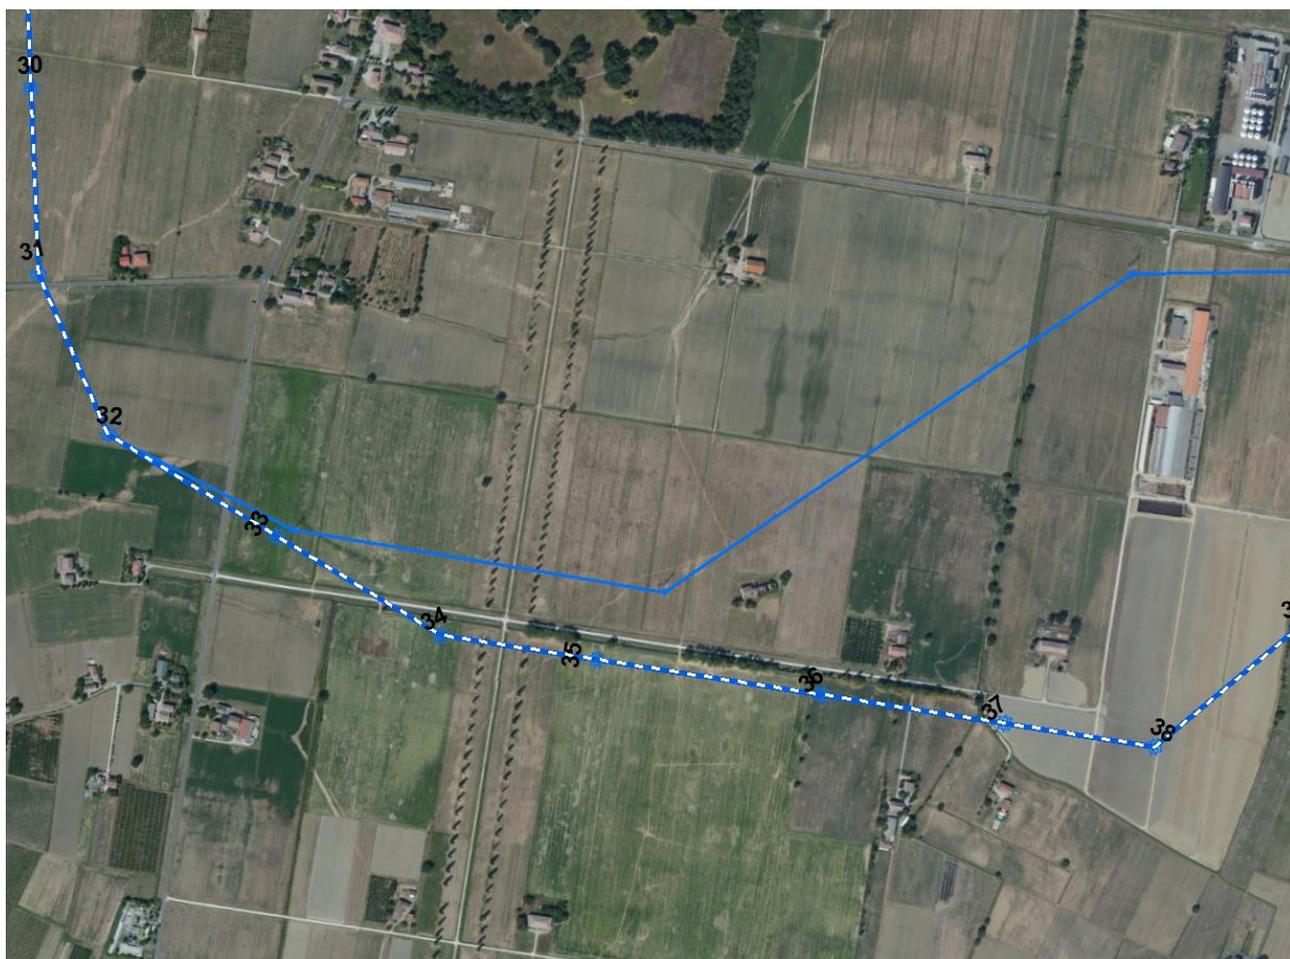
posizionamento dei sostegni oggetto di demolizione e costruzione su ortofotocarta a Sud di Villa Spalletti
